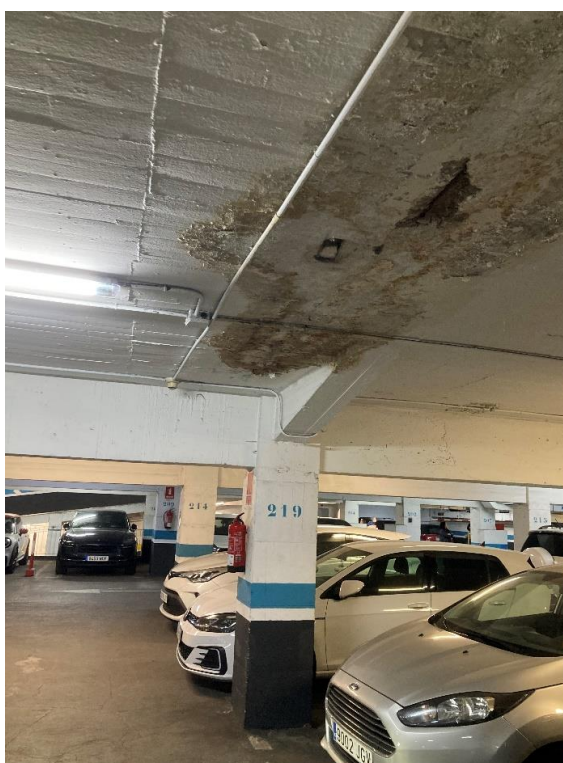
Detalle de humedades en forjado planta S-2 y pérdida de recubrimiento del hormigón
